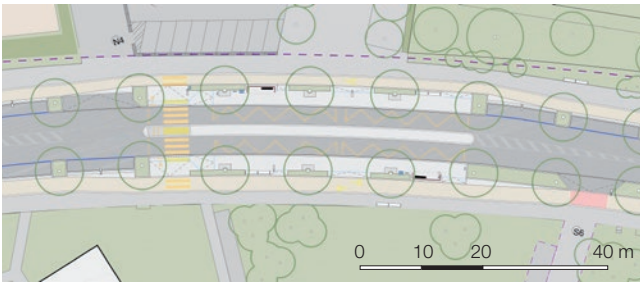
Plan Bushaltestelle (Atelier ADR)
